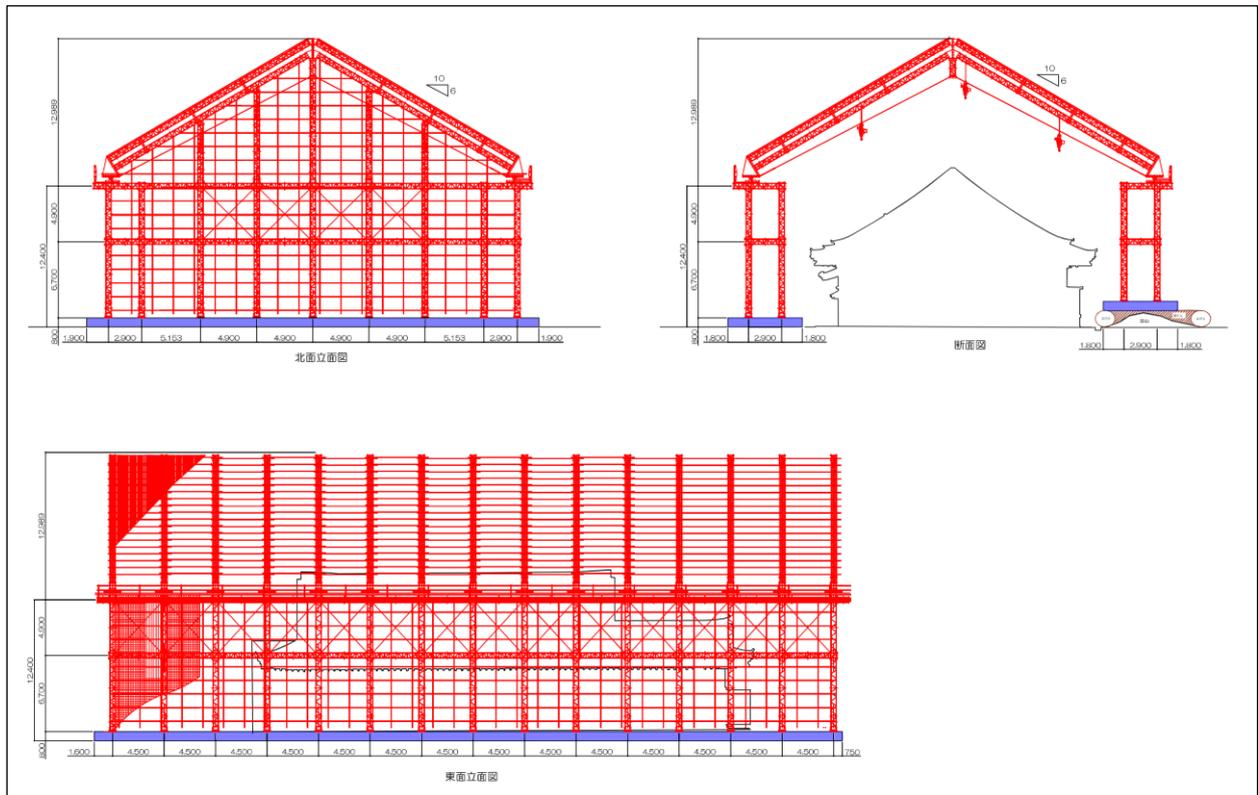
素屋根立面图·断面图（台所）（A工区）
